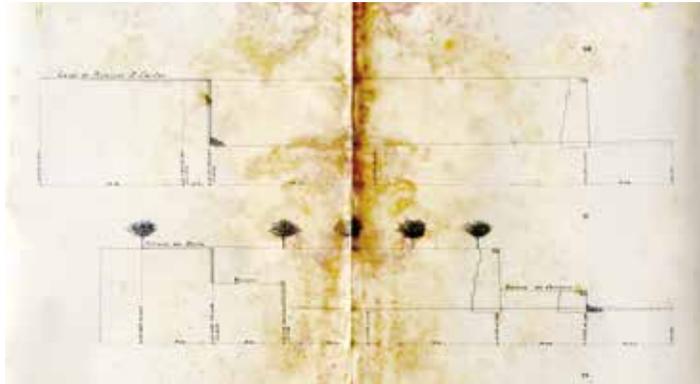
Excerto do desenho da 2.^a Circunscricção Hydraulica, *Projecto do alargamento do Caes de Coimbra, Perfil longitudinal e transversal do 2.^o Traçado - Planta*, 14 de dezembro de 1887 (ARHC, n.º 2) São visíveis os perfis transversais 10 e 11
